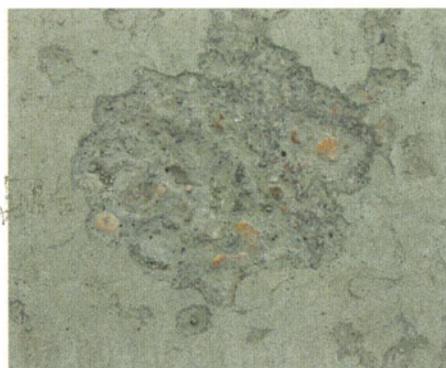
Detailaufnahme der Betonabwitterungen in der Fahrbahn
